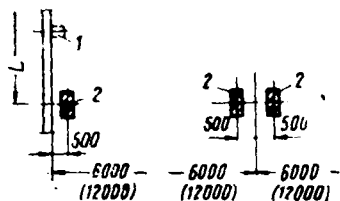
Привязка наружной грани колонн крайних рядов и внутренней поверхности наружных стен к продольным разбивочным осям
